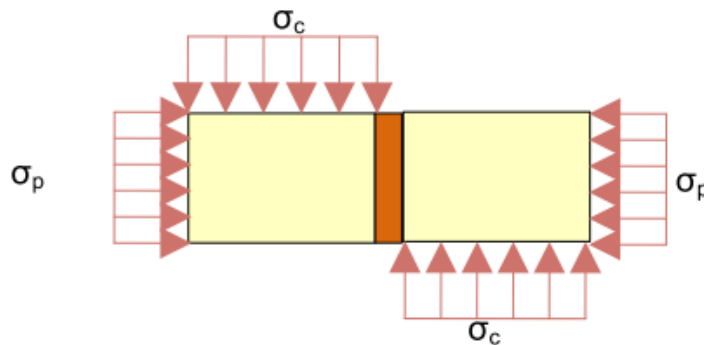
Schéma de principe de l'essai - (Source : Desille (2010))
